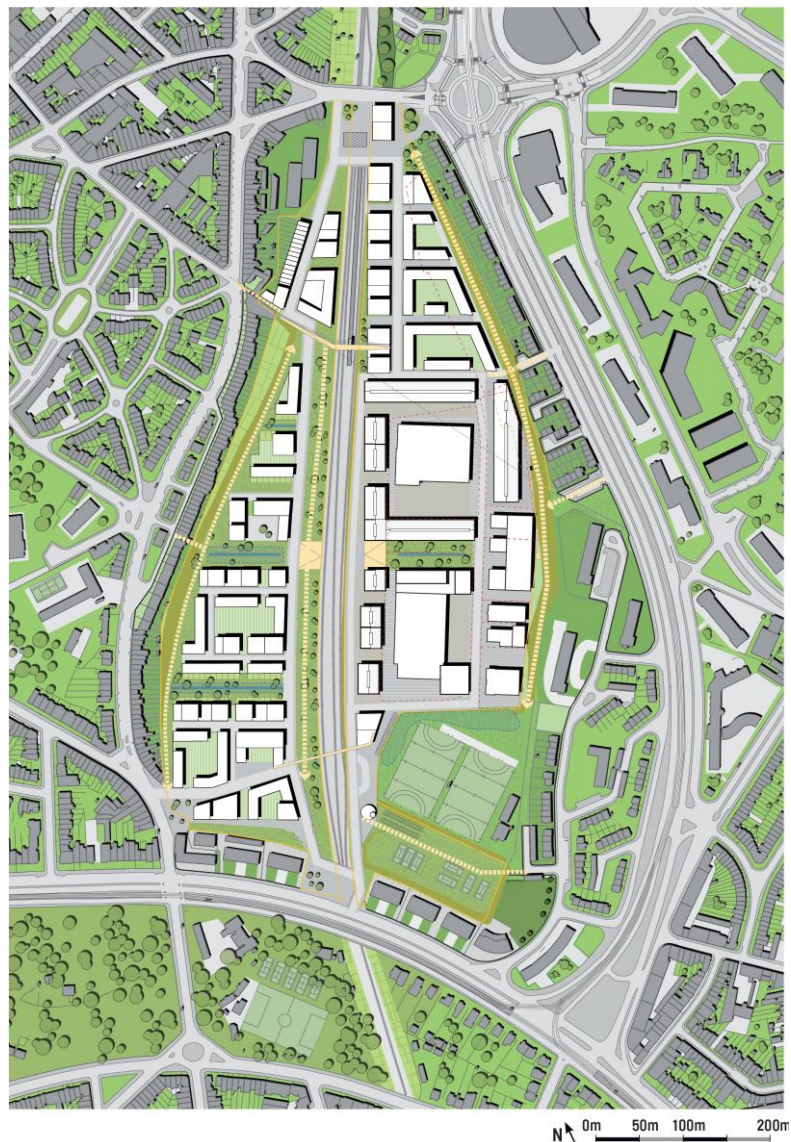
Schéma de plan d'implantation général (SD, 2014)
